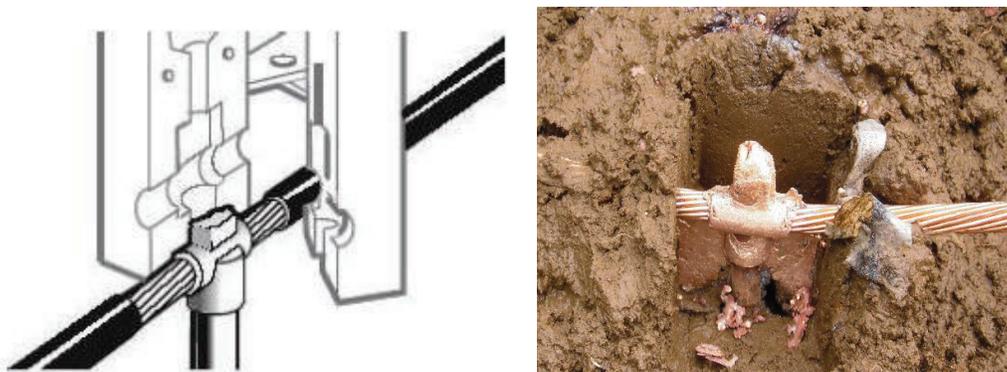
Soldadura exotérmica de la varilla de Copperweld y cable de cobre.
